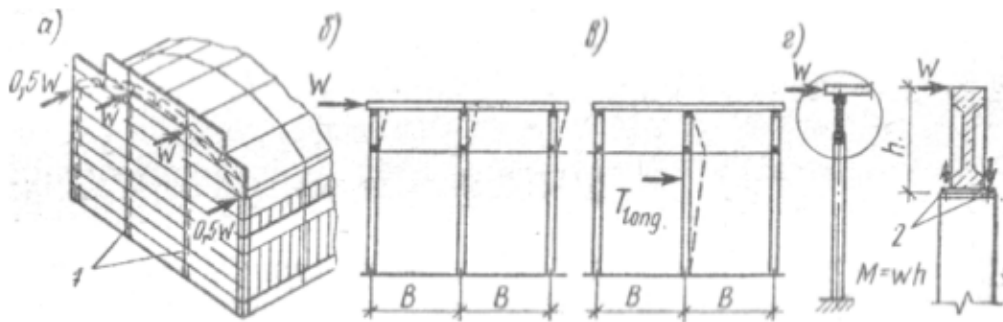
Воздействие горизонтальных нагрузок на продольную раму и покрытие здания: / — стойки торцового фахверка; 2 — сварные швы
